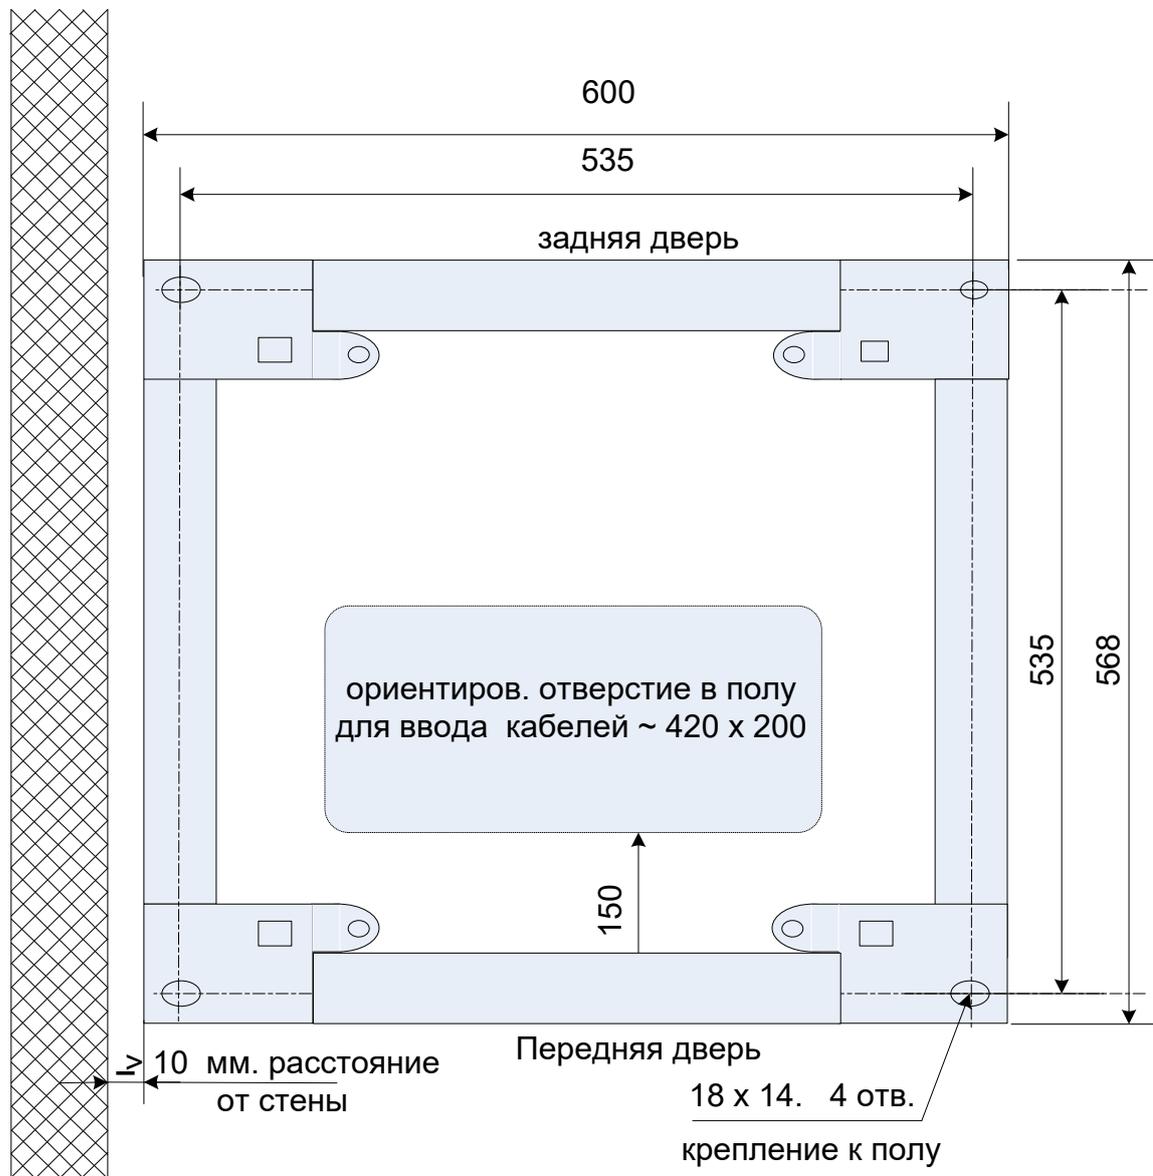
Установочный чертеж для шкафа размером ширины и глубины 600×600 мм
